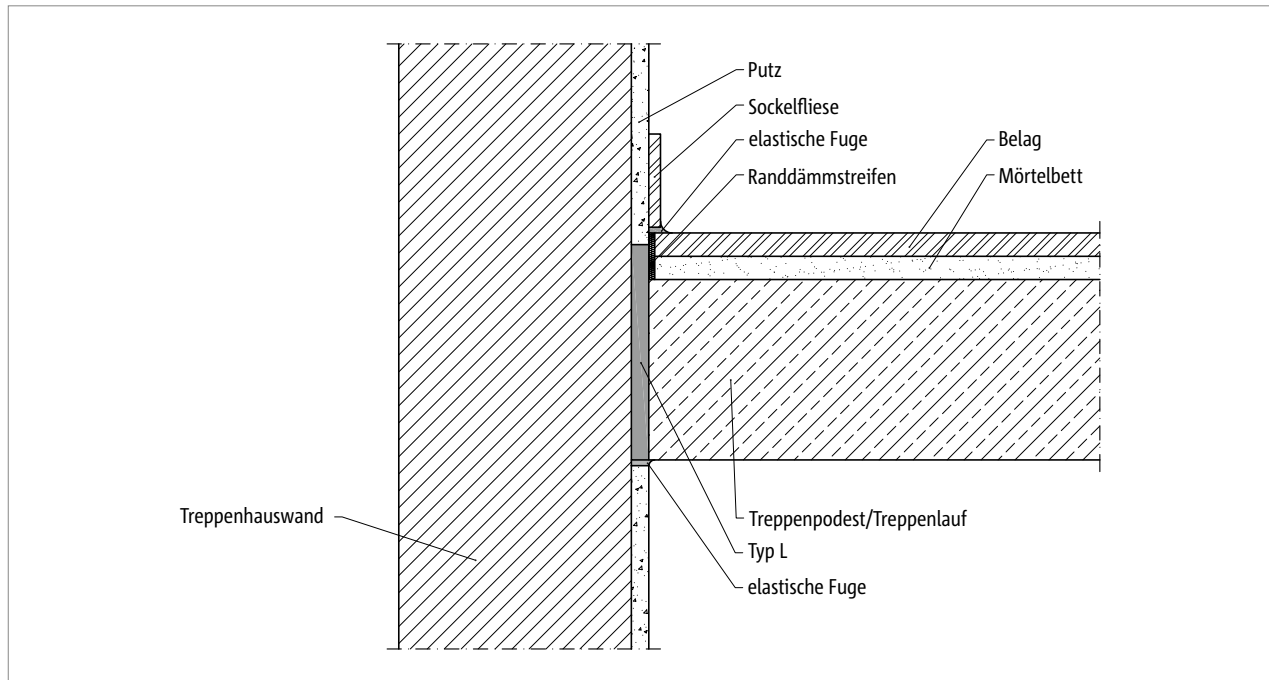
Schöck Tronsole® Typ L: Einbauschritt Ortbetontreppe
